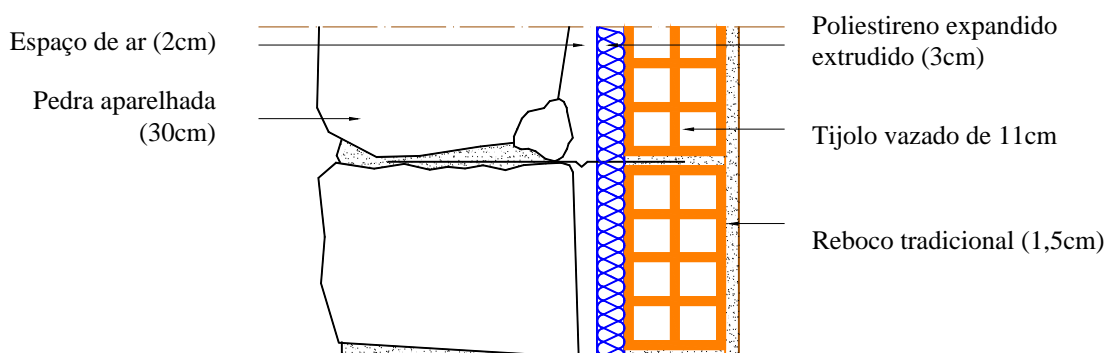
Parede dupla com pano exterior em alvenaria de pedra granítica aparelhada e pano interior em alvenaria de tijolo vazado (Par2)
